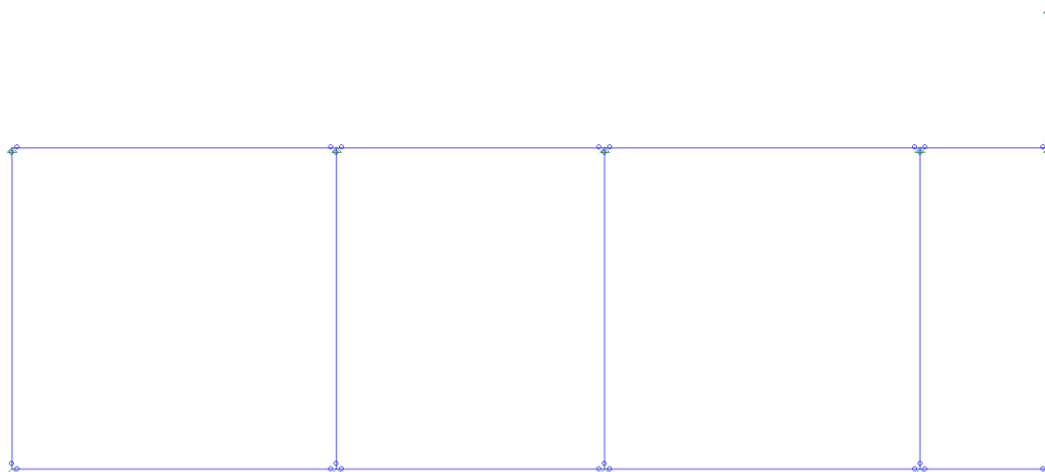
Modelo de análise estrutural para as cargas permanentes e sobrecarga de utilização das vigas metálicas do Anexo 1 (STRAP 2022).
